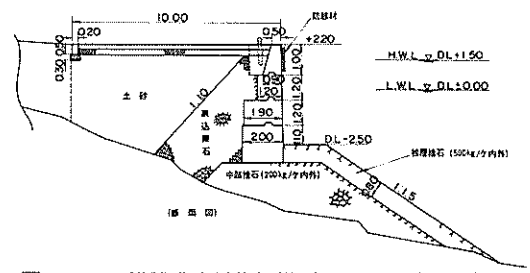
雄勝港唐桑物揚場 (-2.5 m) 標準断面図
